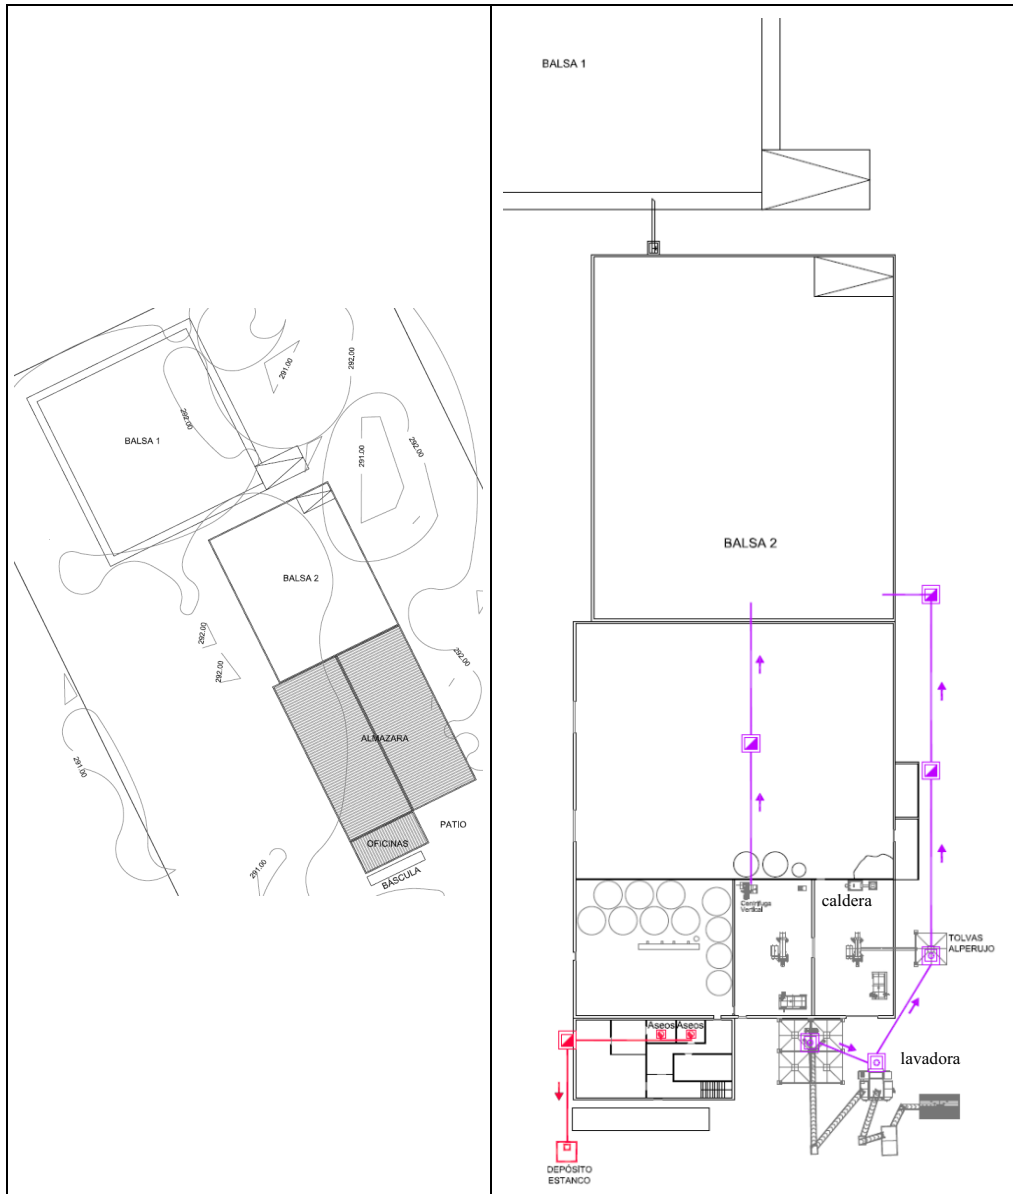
A la izquierda, plano en planta de las instalaciones en la parcela; a la derecha, redes de saneamiento de la nave de almazara.
